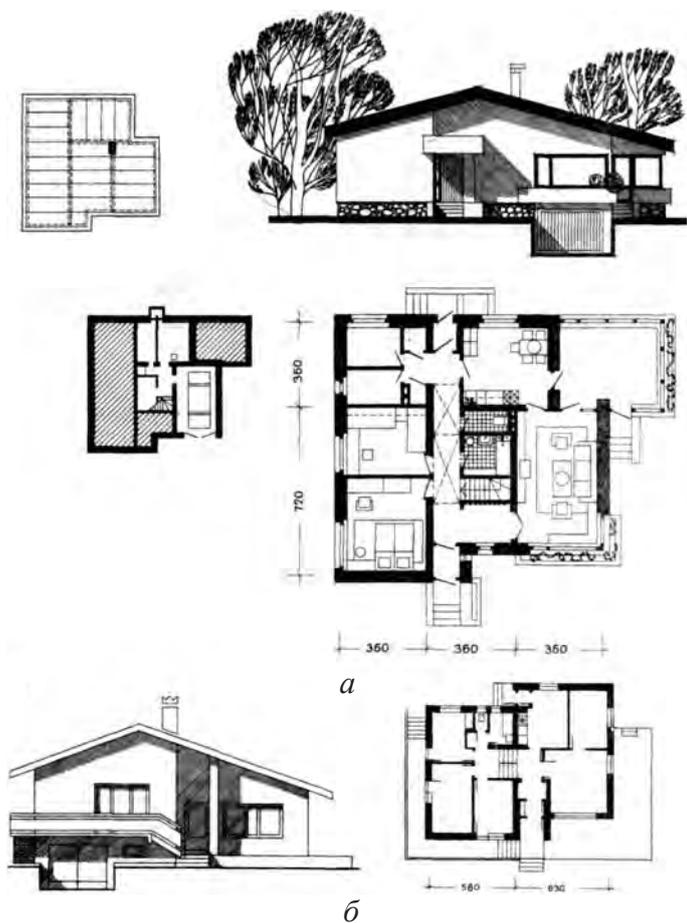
Примеры домов с входами со стороны улицы, с расположением хозяйственной зоны с задней стороны дома: *а* — трехкомнатный дом; план перекрытия, план подвала, план первого этажа; *б* — четырехкомнатный дом
